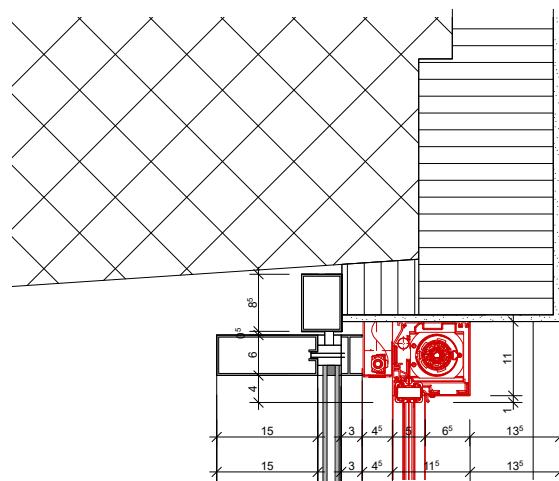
/ Sturz EG Süd-West-Fassade Kantine
